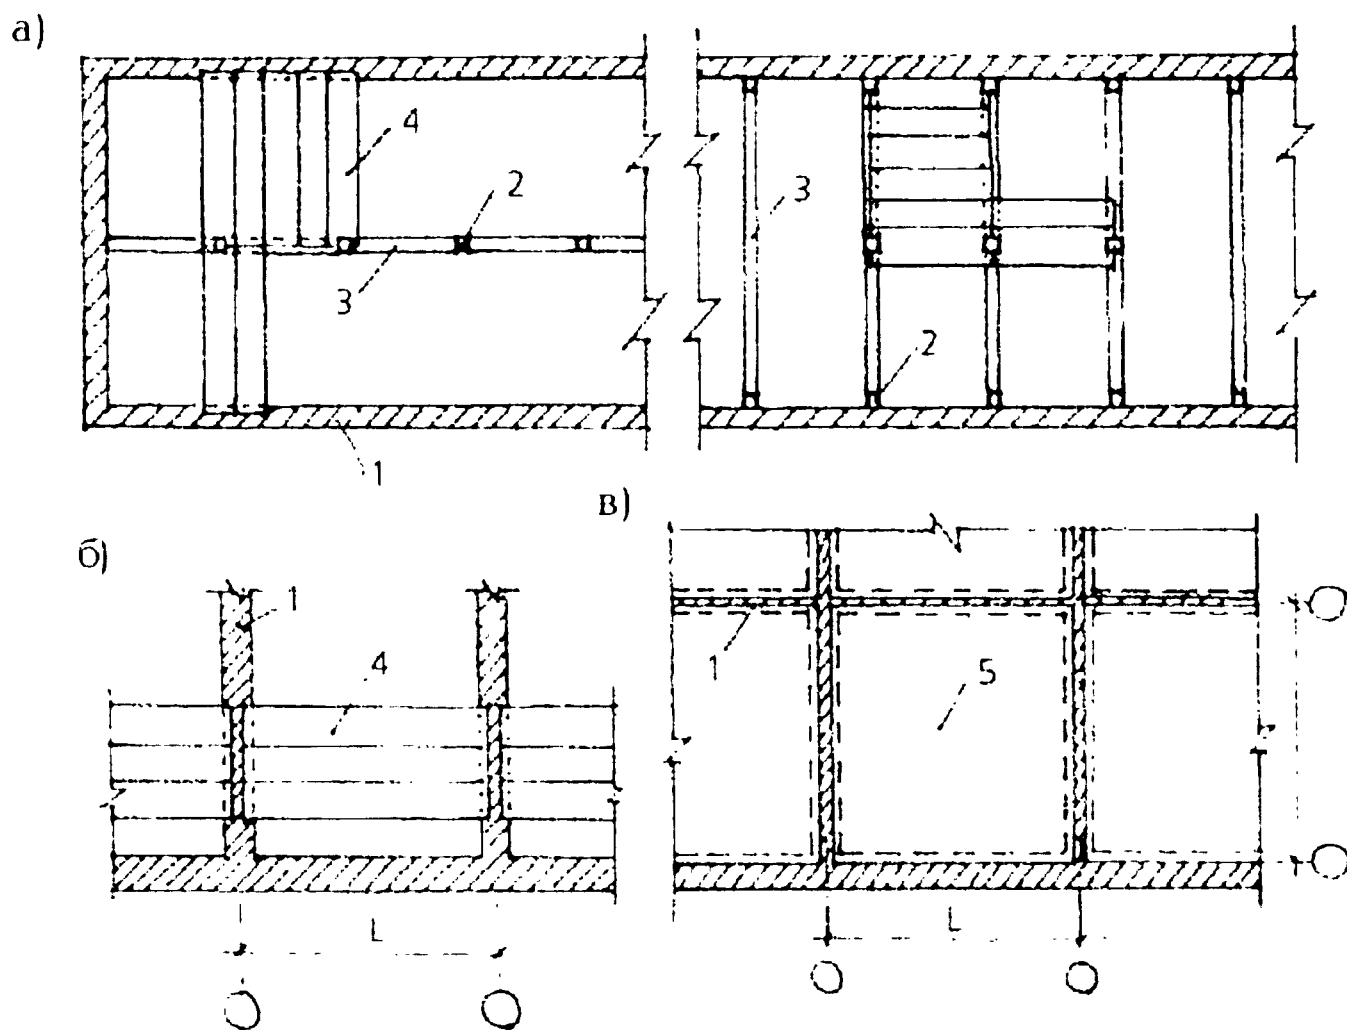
Схемы перекрытий: а - балочные перекрытия; б - безбалочные перекрытия в виде настилов; в - безбалочные перекрытия в виде панелей размером «на комнату»; 1 - несущая стена; 2 - колонна; 3 - ригель; 4 - настил (панель); 5 - панель размером «на комнату»
